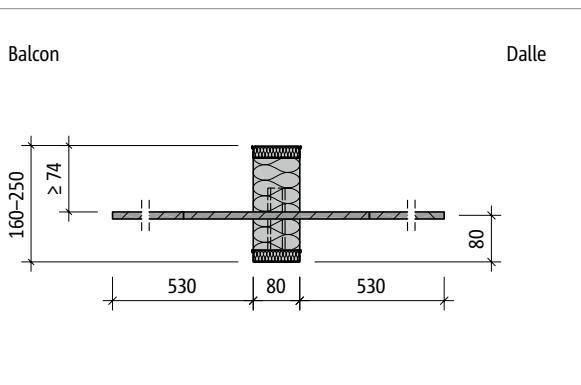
Schöck Isokorb® T Type H-NN2 : Coupe du produit
